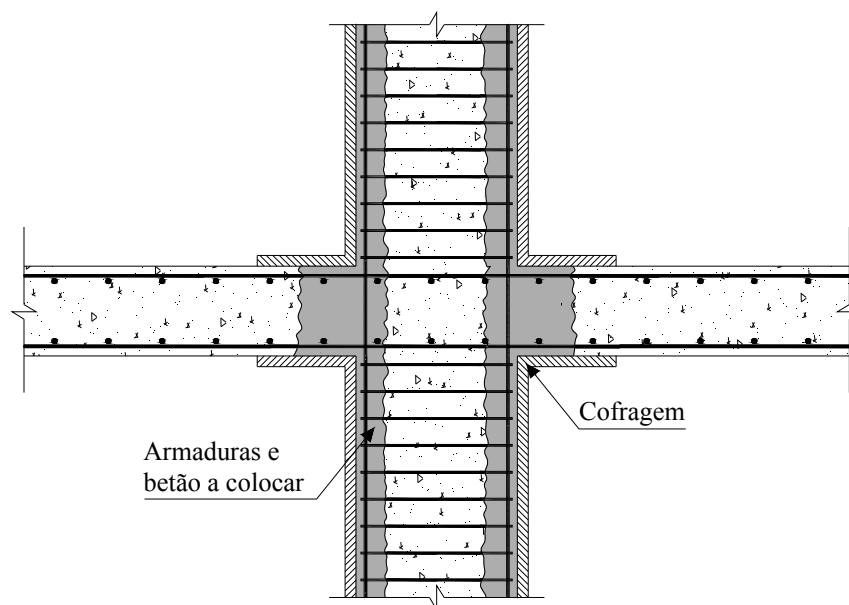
Esquema de reforço ao punçoamento por aumento da secção do pilar
